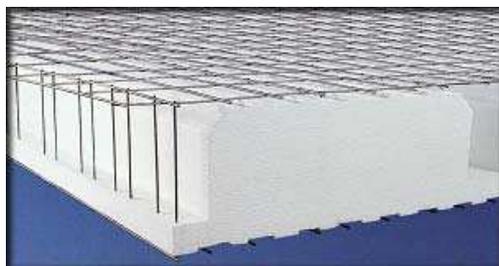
Painel Tipo Laje - (Fonte: <http://www.monoliteintl.com/monopanel.asp>)
